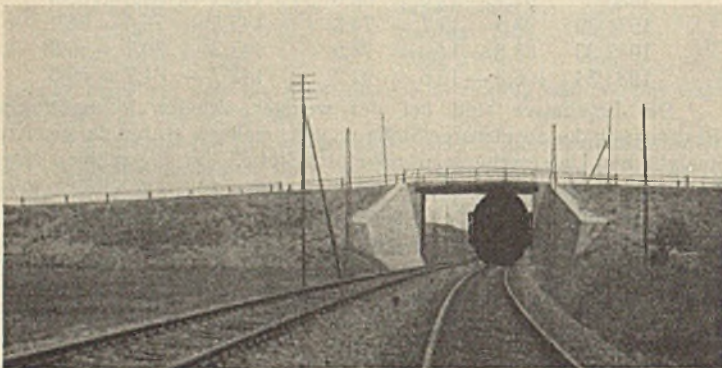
Wegüberführung mit langen Auffahrtrampen im ebenen Gelände.
